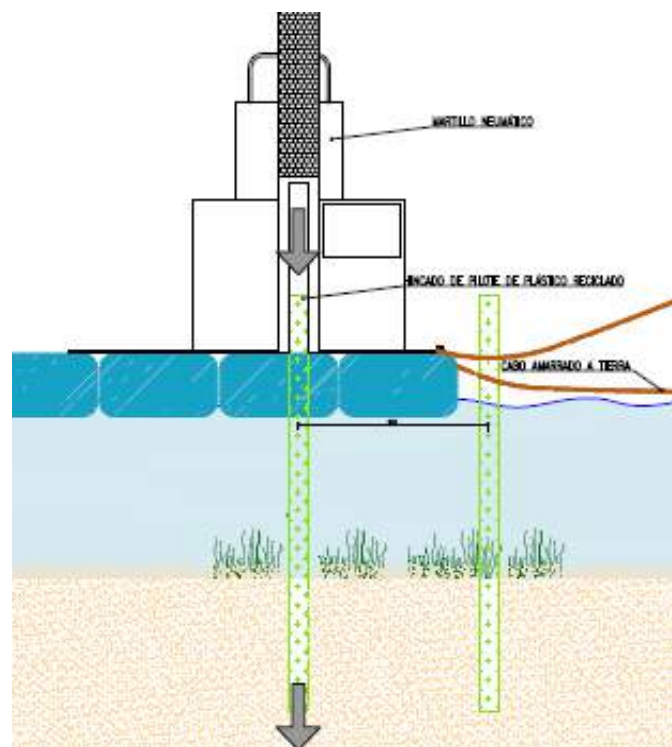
Proceso de colocación de pilares. Fuente: proyecto técnico. Elaboración: Alberto Correa.
